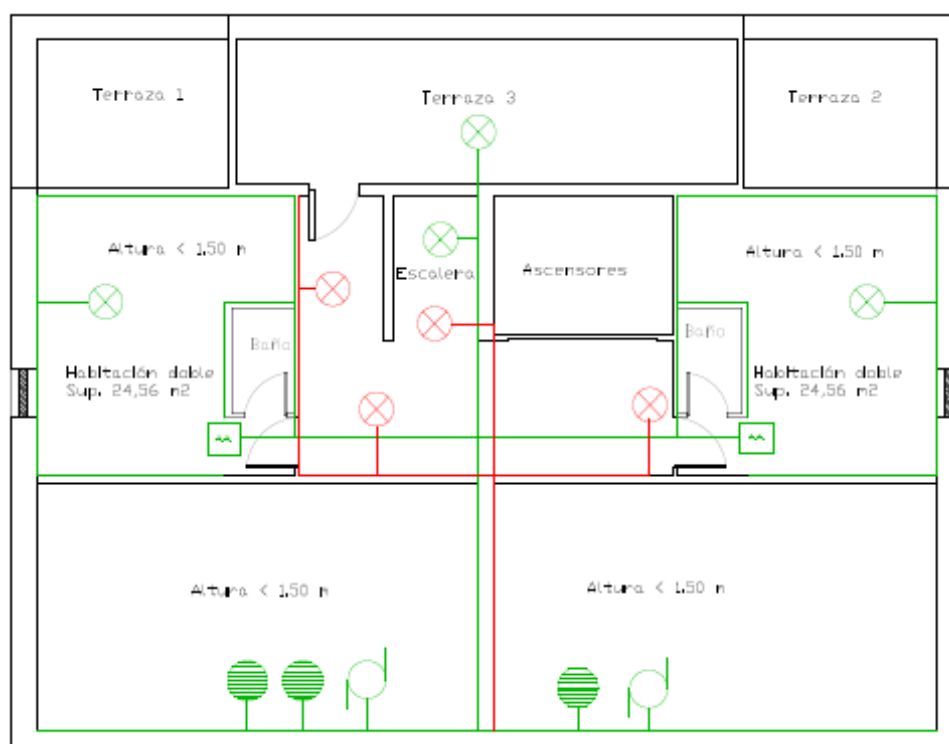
Plano del sistema eléctrico en la planta bajo cubierta. Fuente: Elaboración propia
